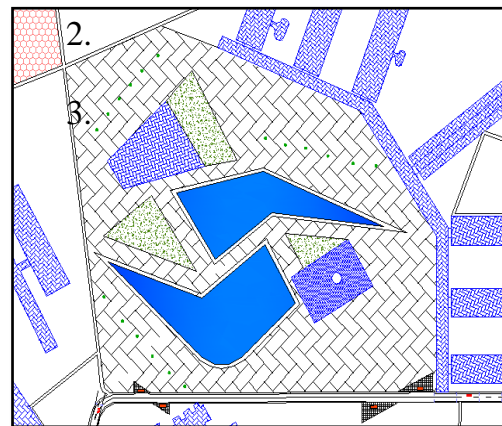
Vue en plan du parc central (plan bleu) après l'intervention
